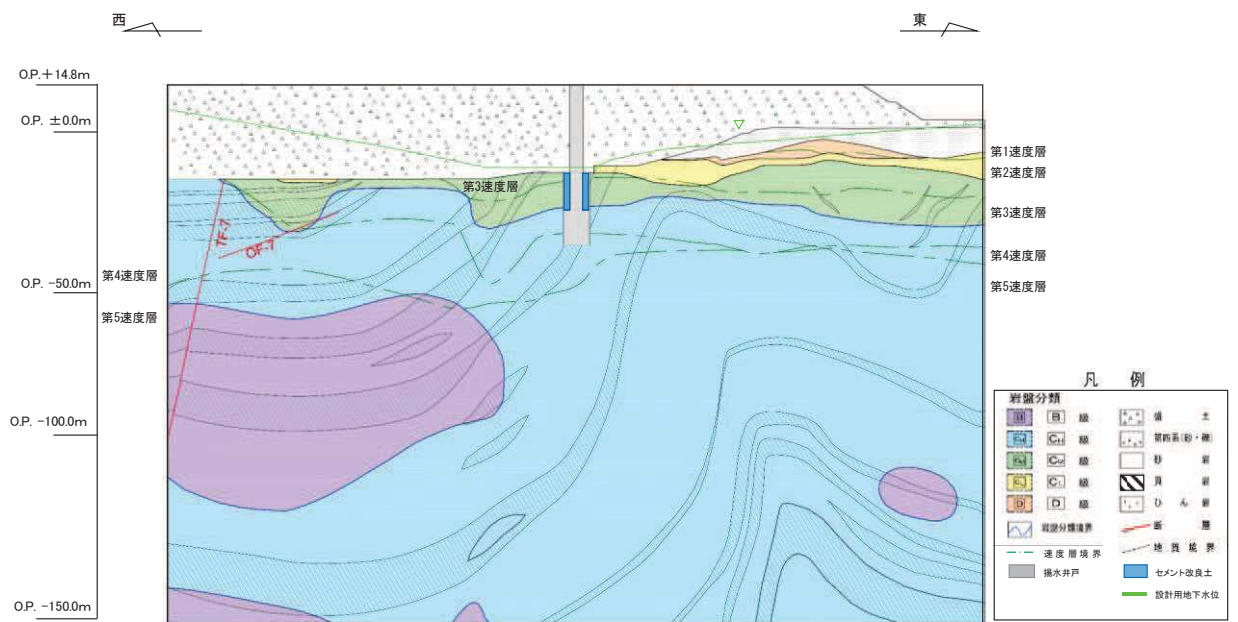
(4) No.4 揚水井戸 評価対象断面図 (D-D' 断面)
